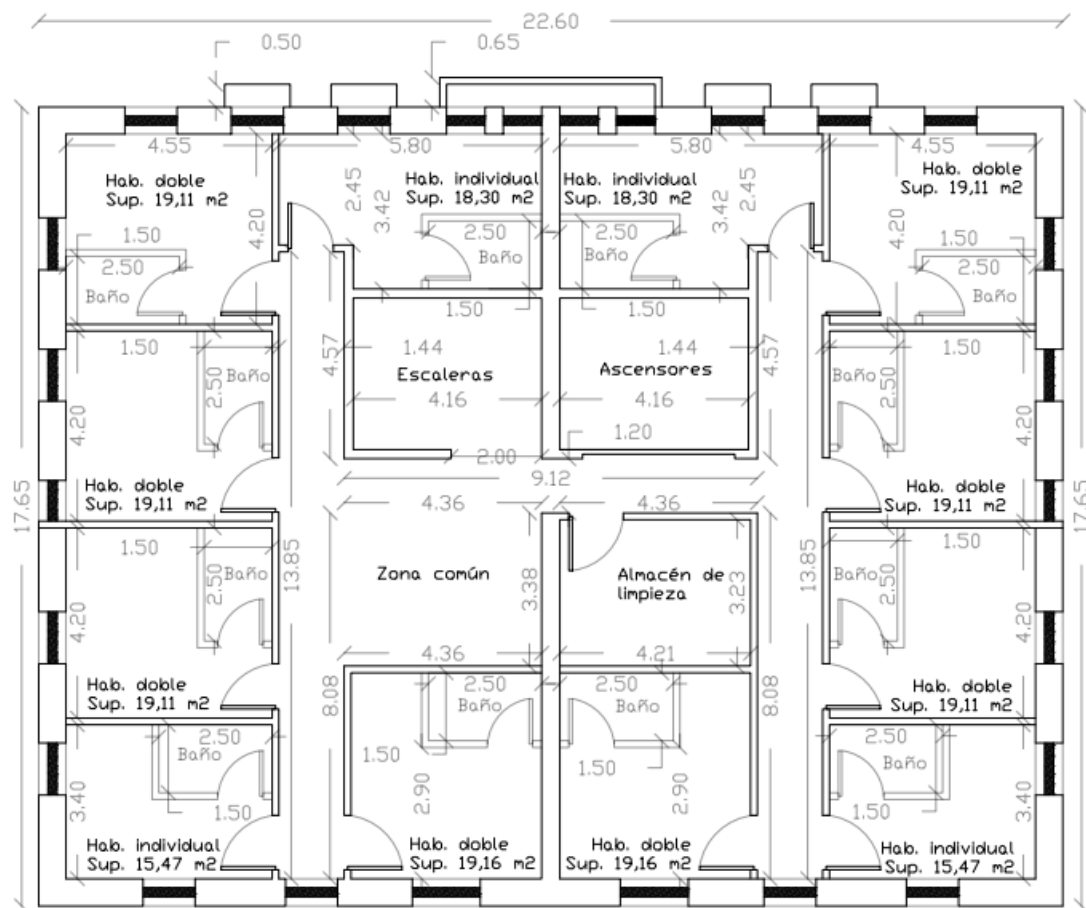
Extracto del plano de la primera planta redistribuida. Fuente: Elaboración propia
